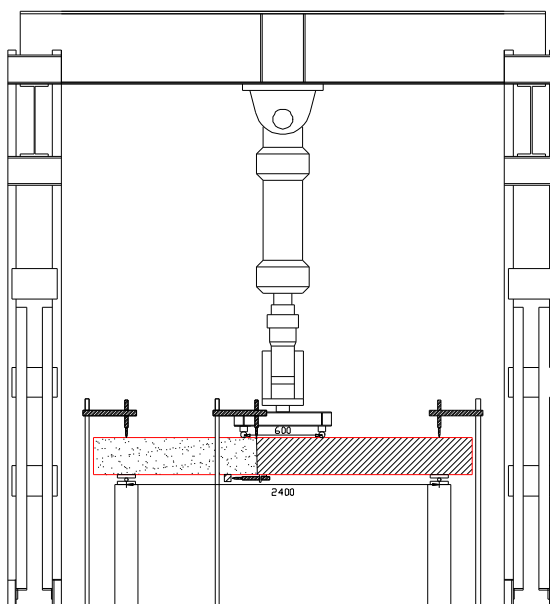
Esquema simplificado del ensayo a flexión.
